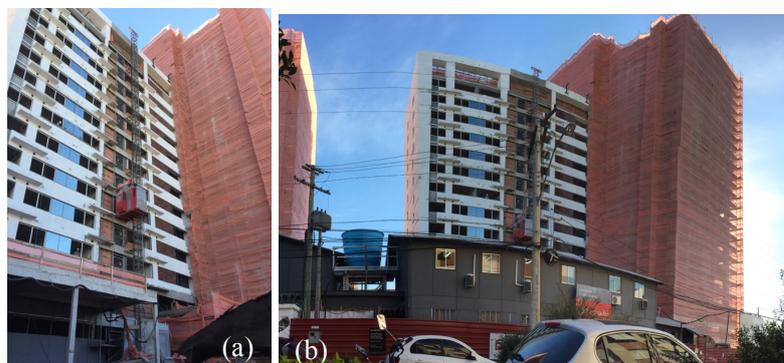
Imagens do canteiro da Obra 1 em agosto de 2016
